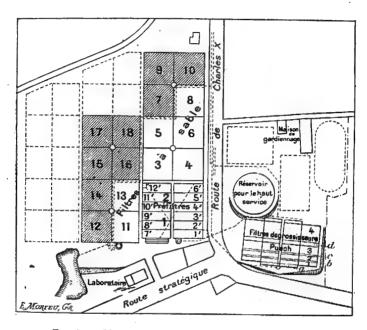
Plan d'ensemble de l'installation filtrante.
